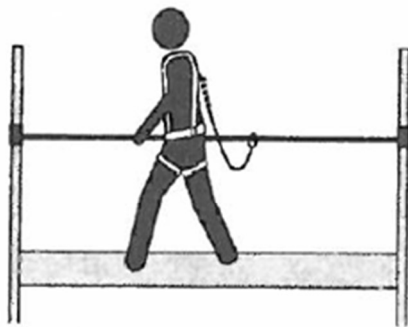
Příklady zajištění volných okrajů střech proti pádu technickou konstrukcí
